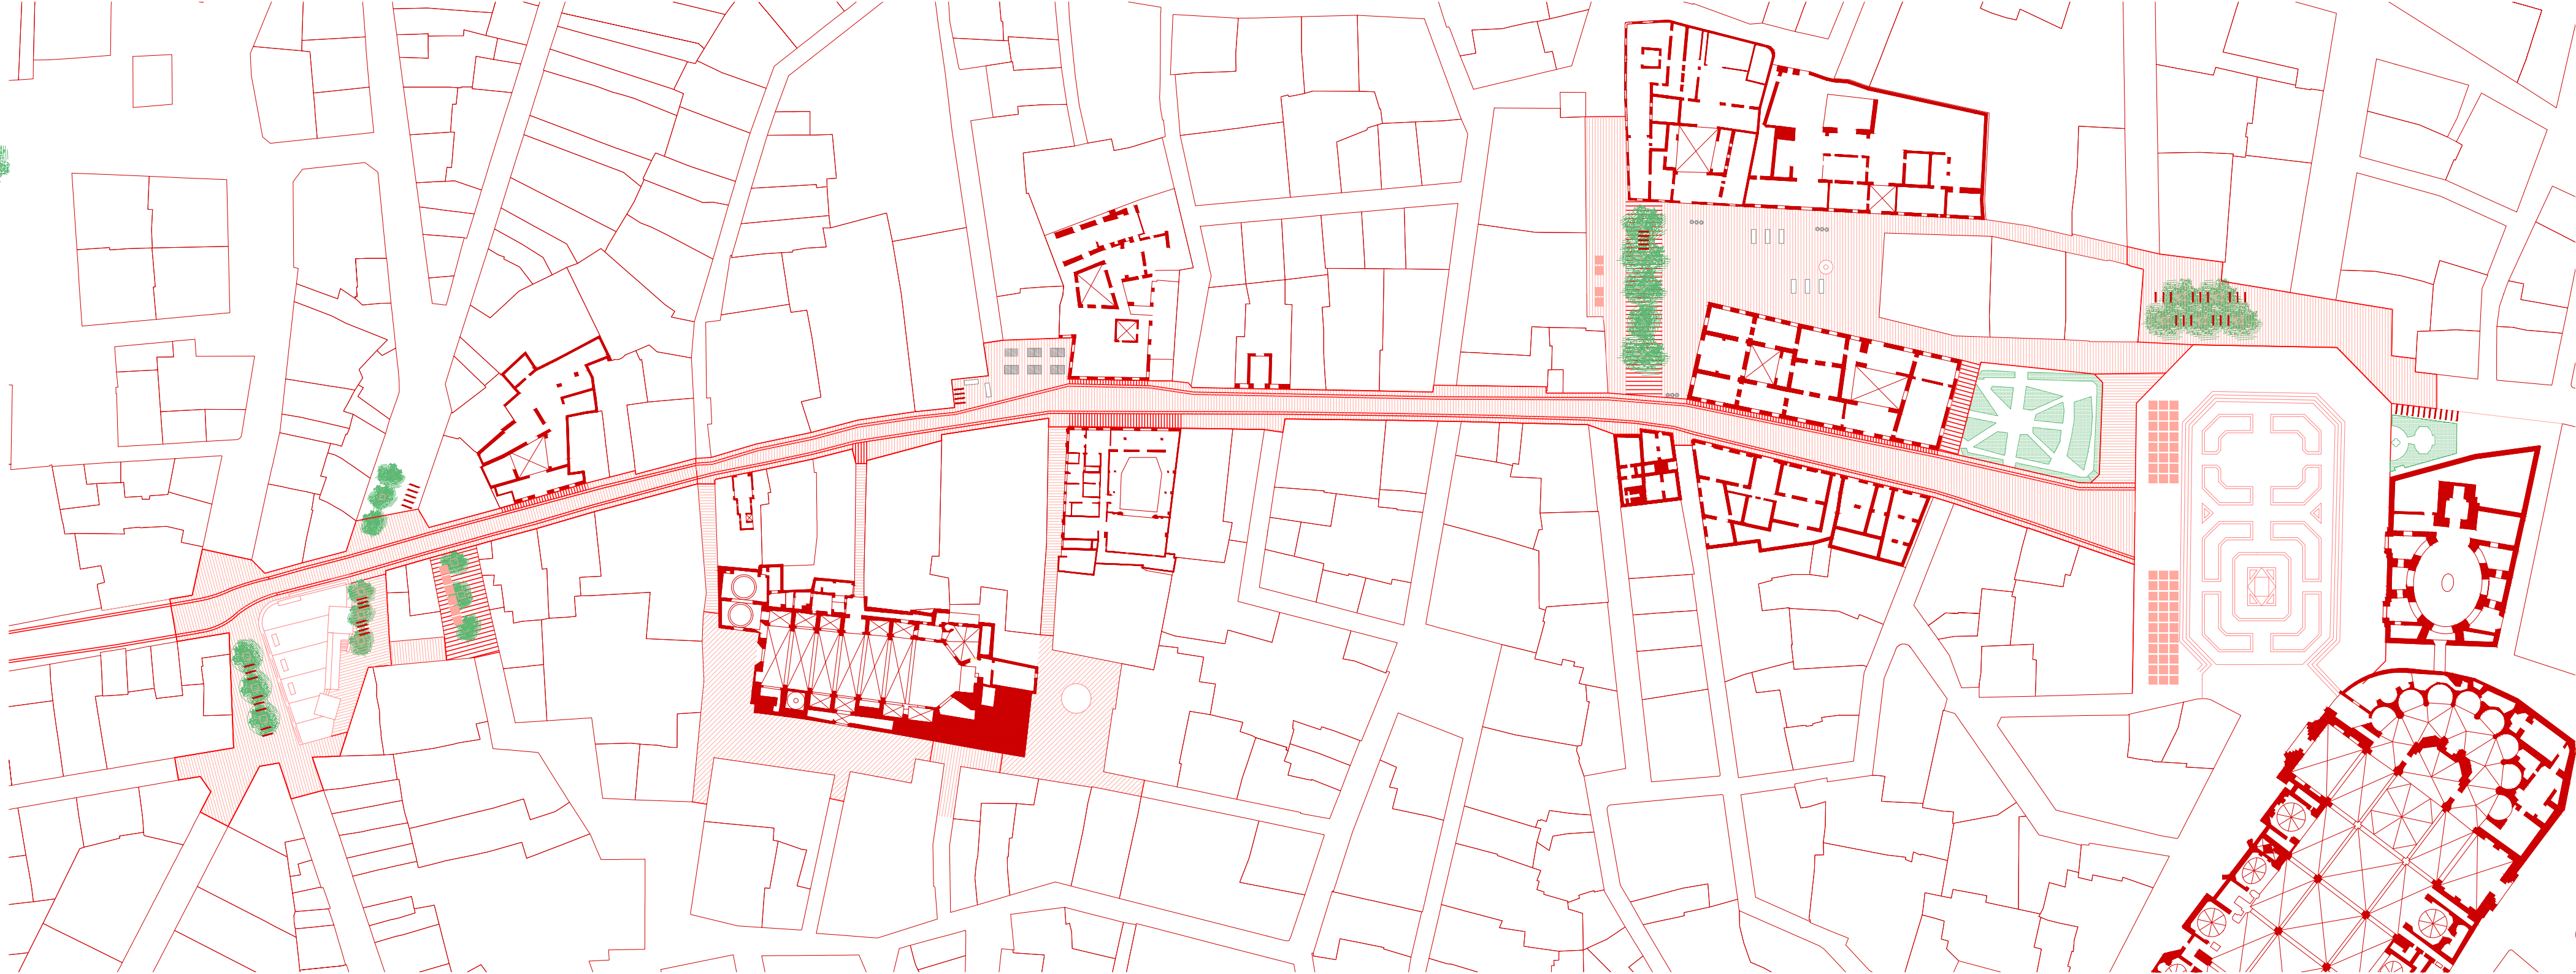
Plano Propuesta de zonas verdes en Cavallers. E: 1/1000
